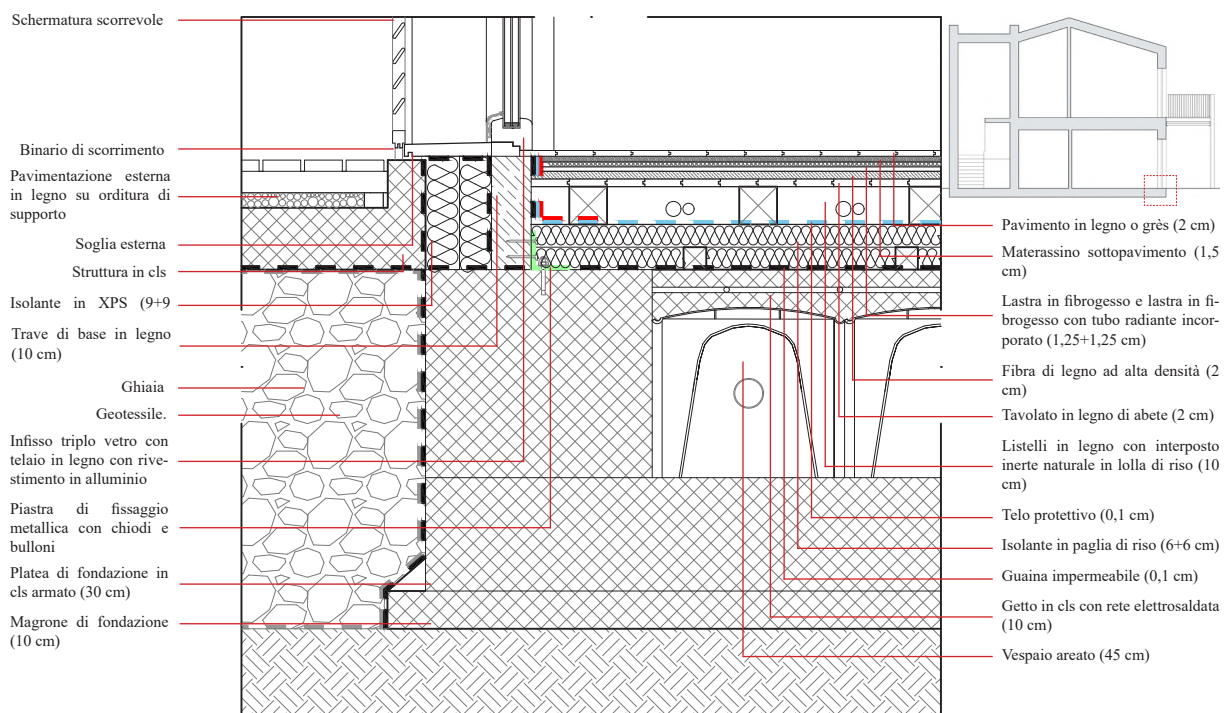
Nodo solaio a terra - parete perimetrale con pavimentazione esterna in legno (scala 1:20)
